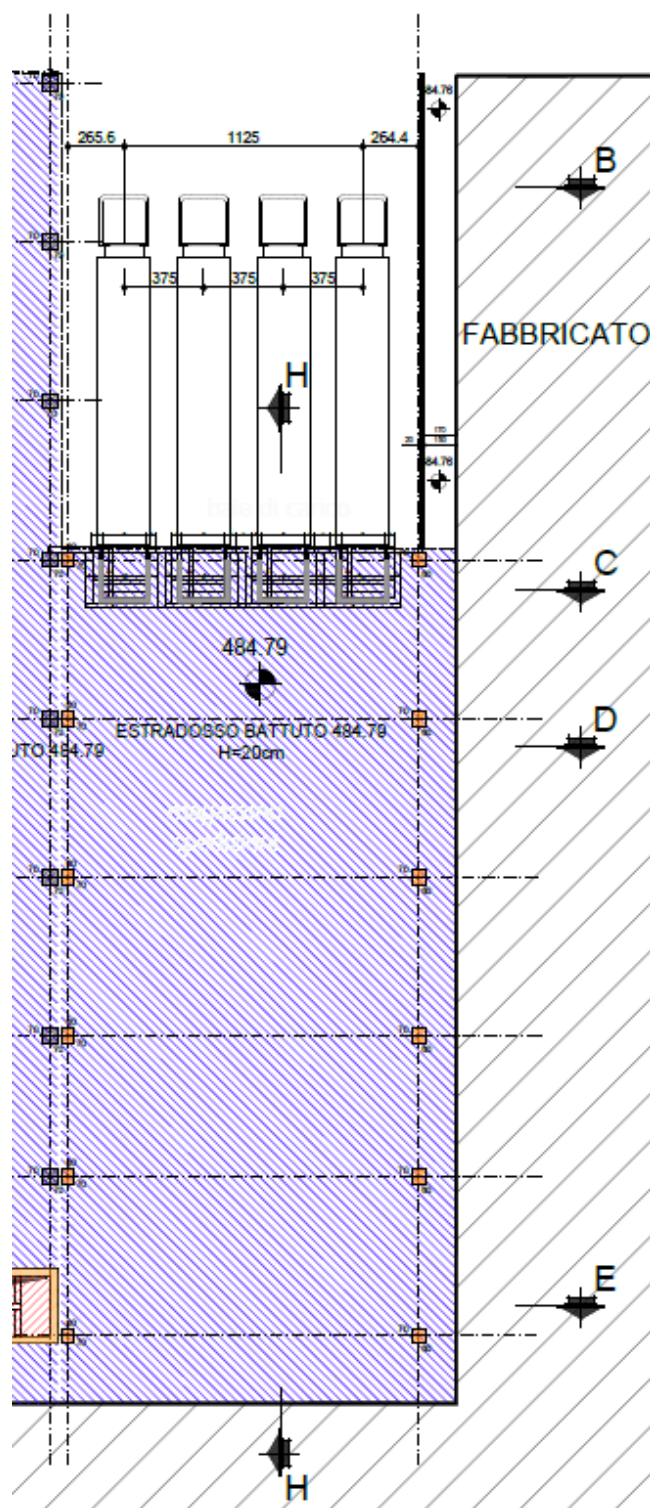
Planimetria piano P0 - Nuovo magazzino spedizioni
